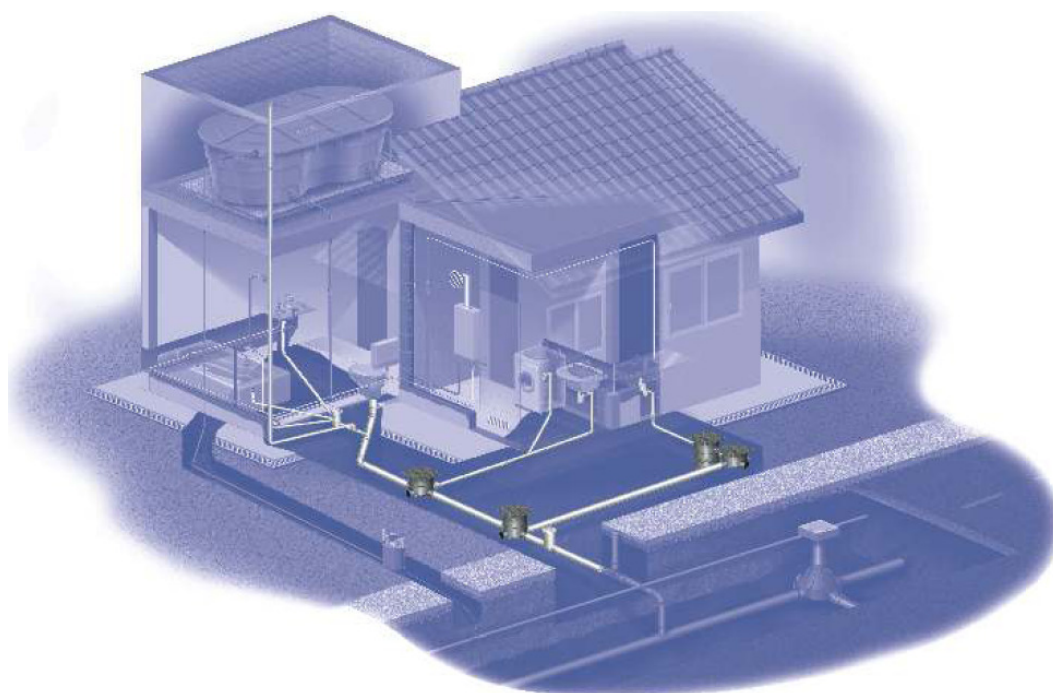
Vista geral da distribuição de um sistema esgoto sanitário
